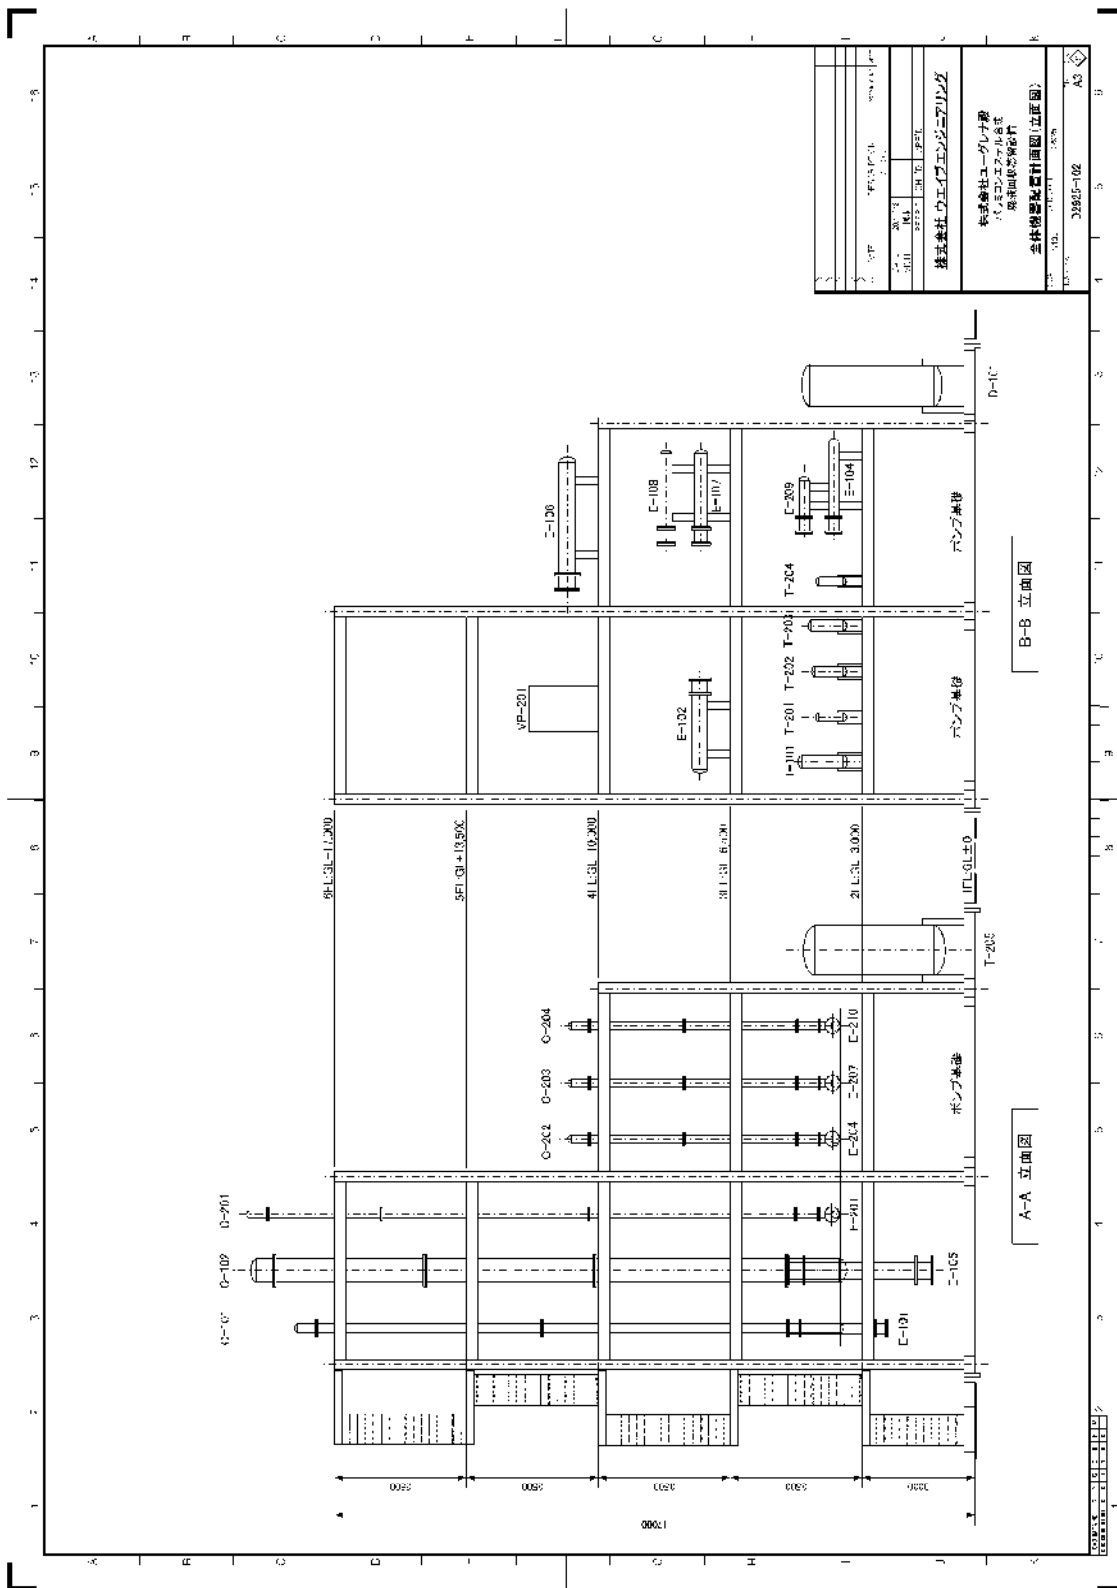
廃液回収蒸留設備の概略機器配置 立面図
